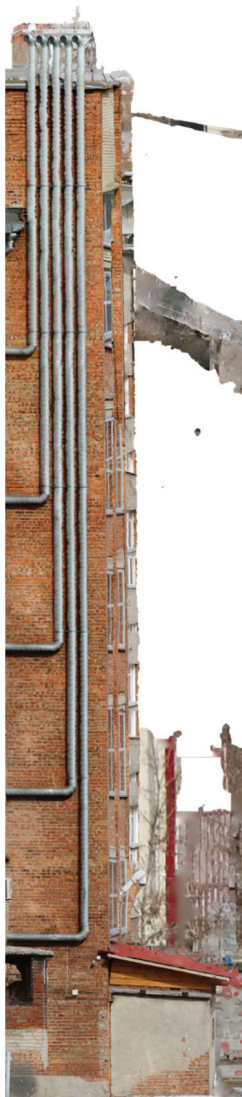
Вентиляционные трубы на фасаде зданий
